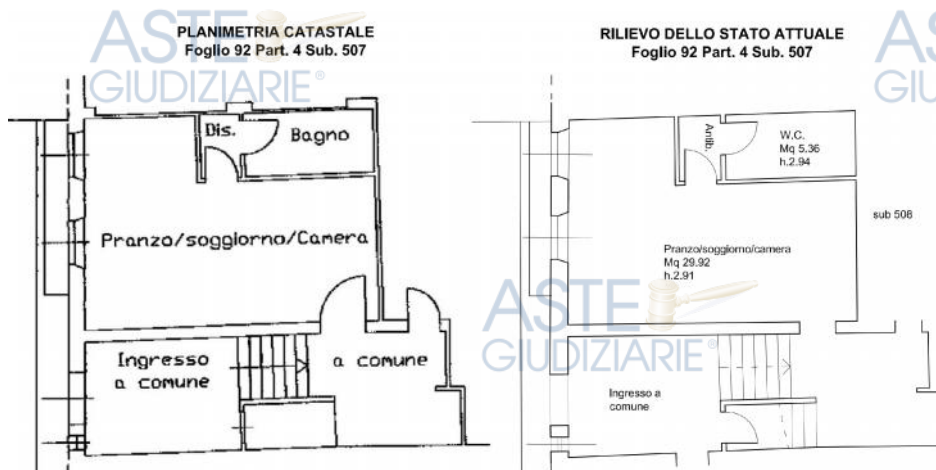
Sovrapposizione fra lo stato di rilievo e la planimetria catastale sub 507
